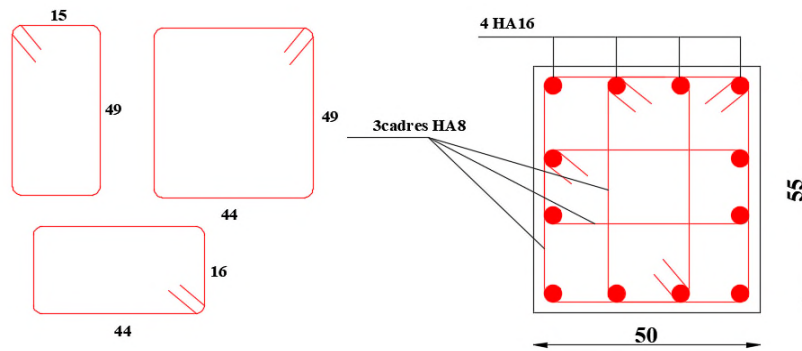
Schéma de ferrailage des poteaux du étages RDC et S-sol
